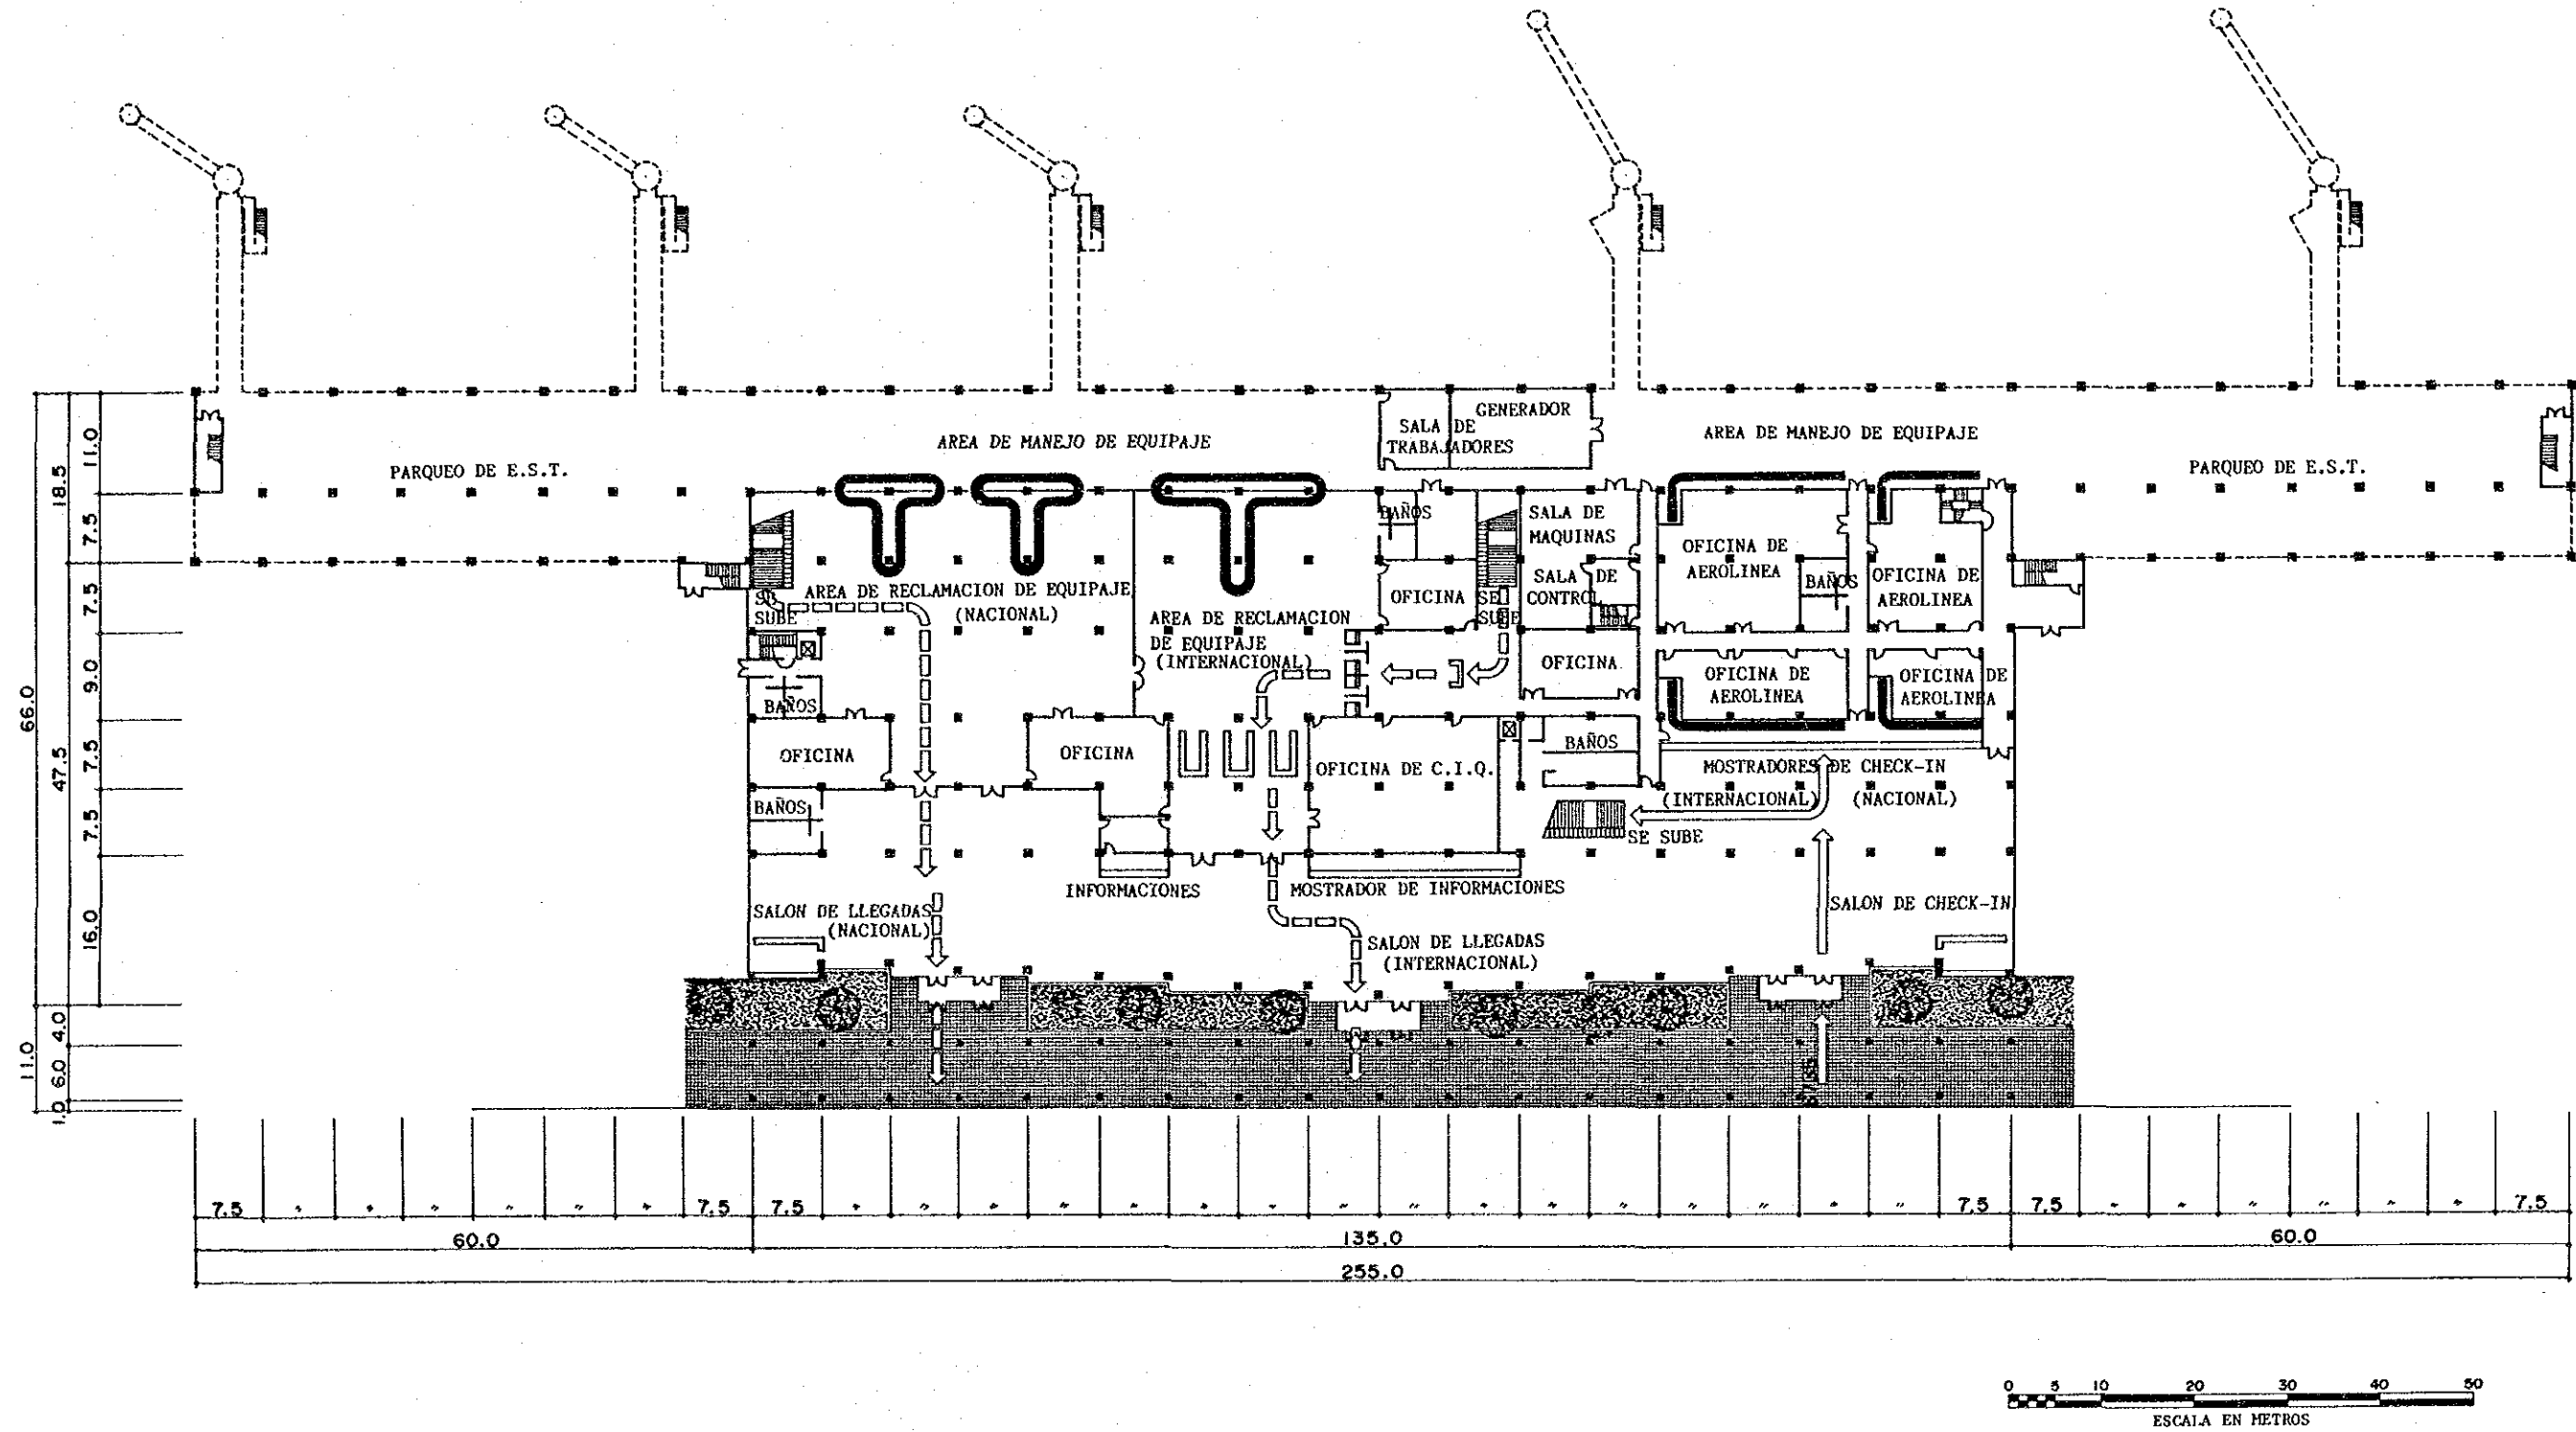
Plano del Piso Bajo del Edificio Terminal de Pasajeros
